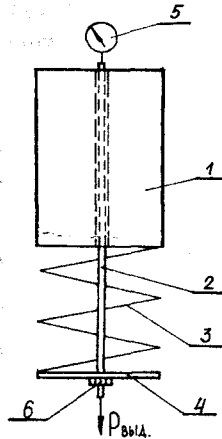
Схема испытаний анкерных соединений по определению деформаций в случае воздействия на арматурный стержень длительно действующего выдергивающего усилия: 1 – бетонный образец; 2 – анкерный стержень; 3 – силовая пружина; 4 – опорный диск; 5 – часовой индикатор; 6 – фиксирующая гайка
